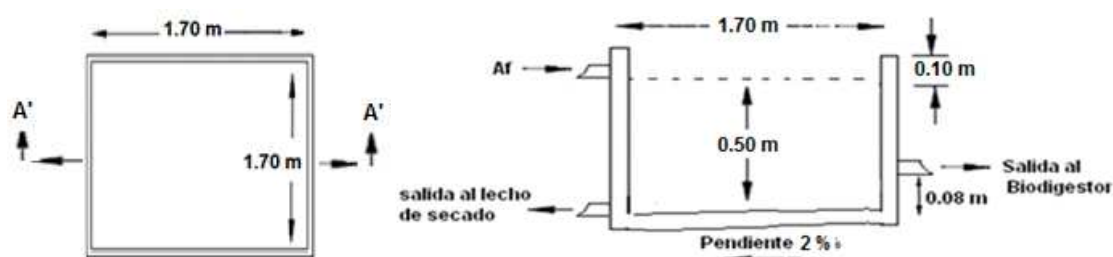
Vista en Planta y Corte A' del tanque de sedimentación
